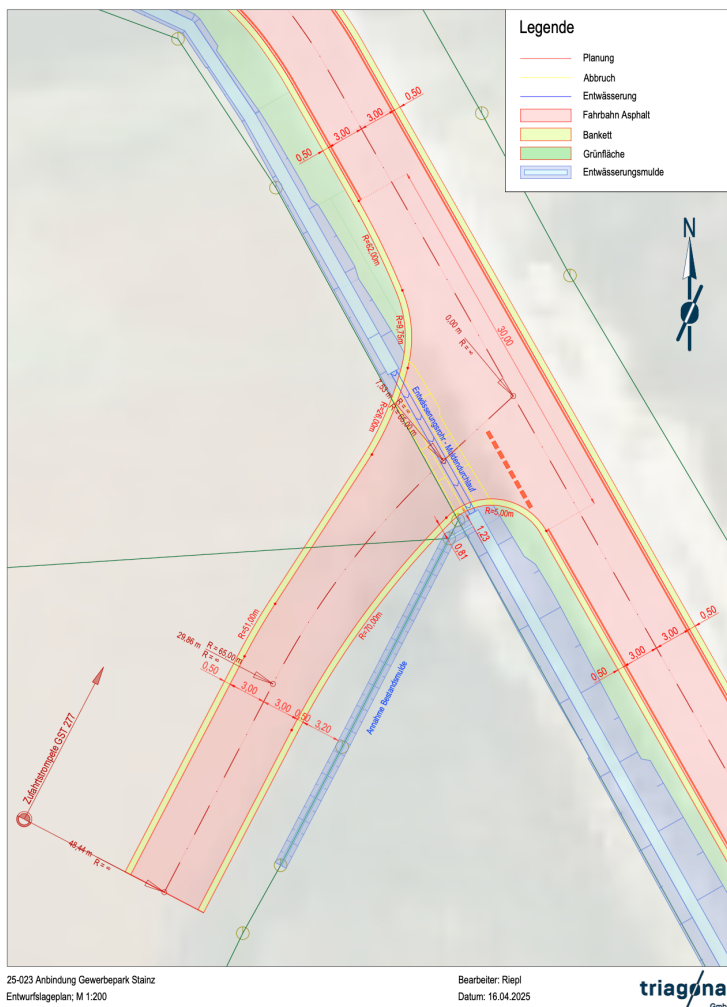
Ausschnitt Entwurfslageplan Anbindung (Quelle: Triagonal GmbH)
